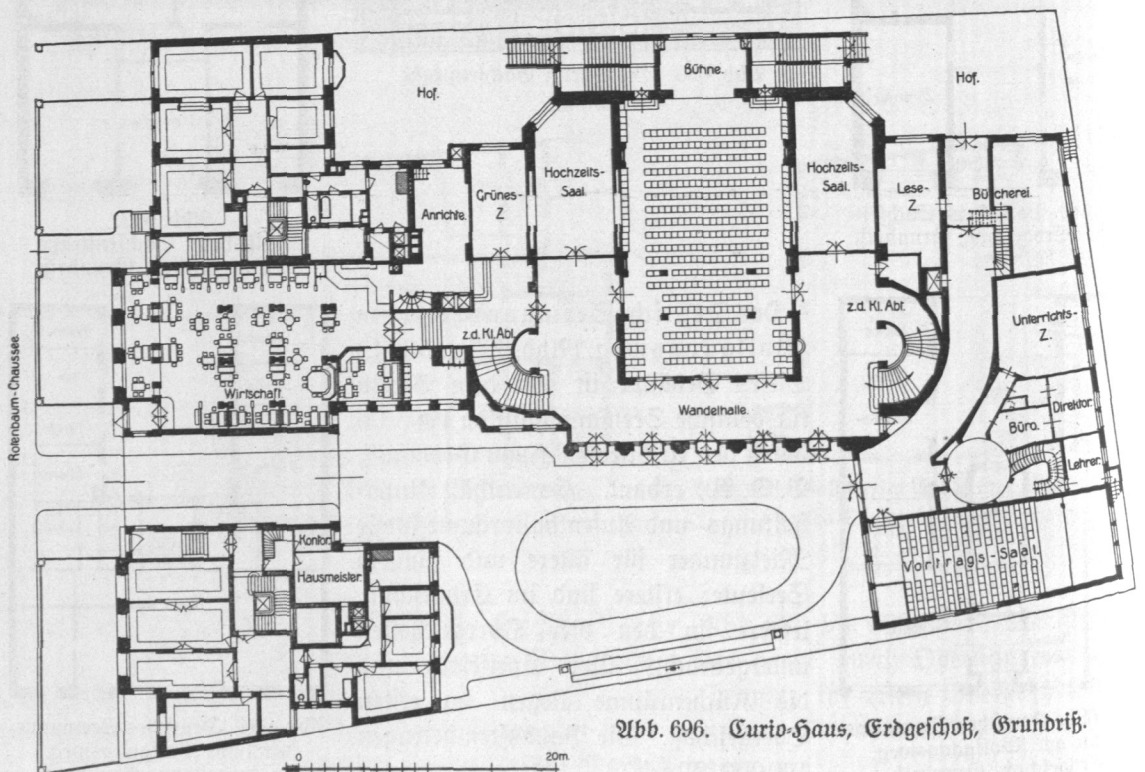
Curio-Haus, Erdgeschoß, Grundriß.
